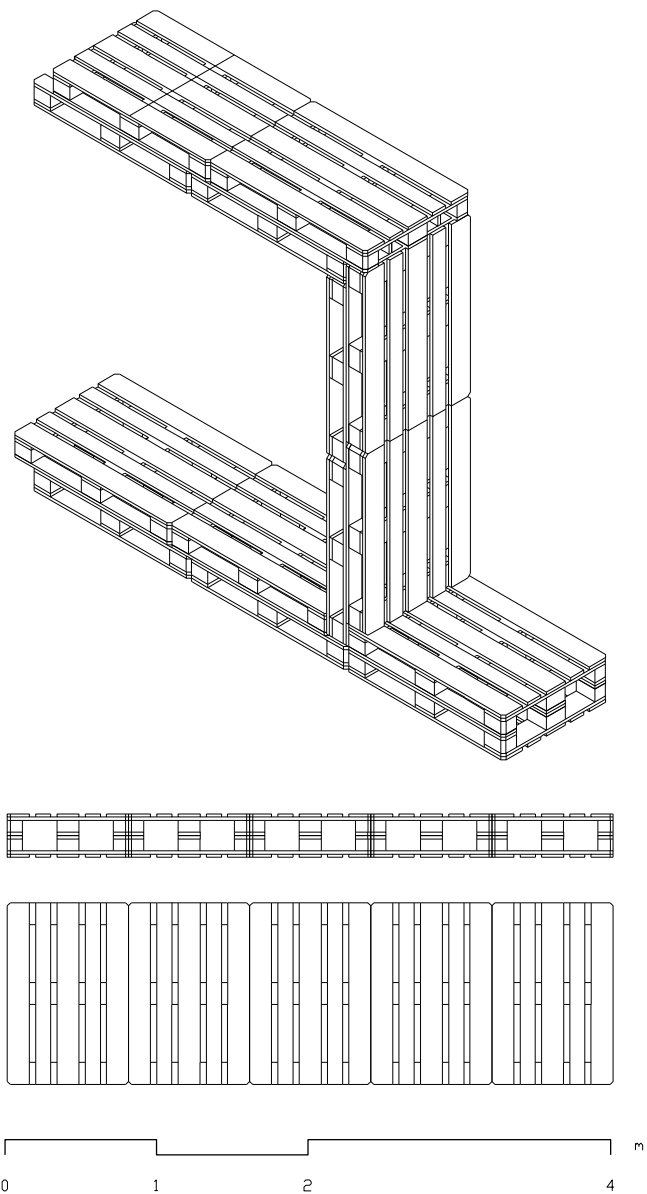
assonometria di un possibile assemblaggio (in alto). Pianta e prospetto di una fila di pallet ribaltati e accostati.
